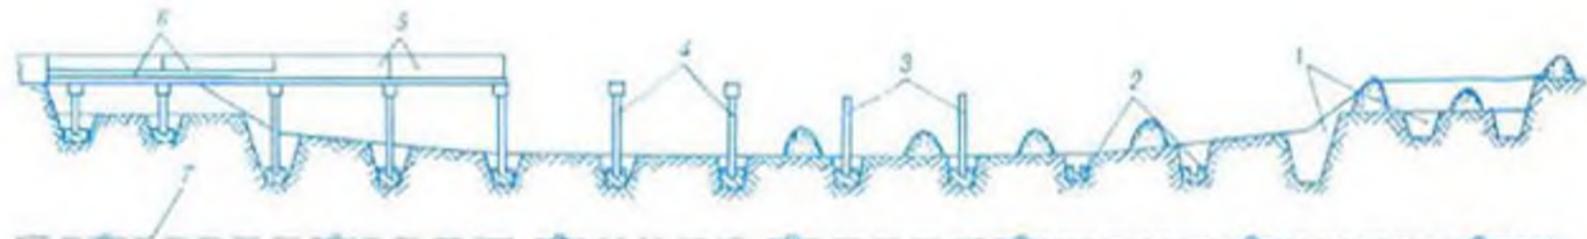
Монтаж гидротехнических сооружений. Схема монтажа акведука: 1 — разработка грунта в котлованах под опоры; 2 — установка балочков; 3 — установка и закрепление стоек; 4 — установка и закрепление прогонов; 5 — установка и закрепление плит; 6 — установка и закрепление прогонов; 7 — ось продолжения и рабочие позиции кранов.
